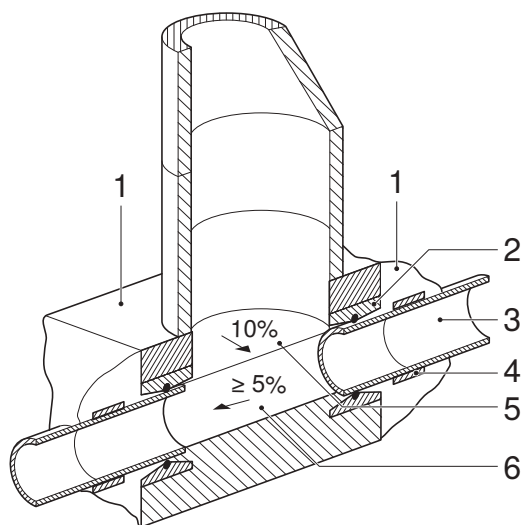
Spojenie s prefabrikovanou šachtovou prípojkou
